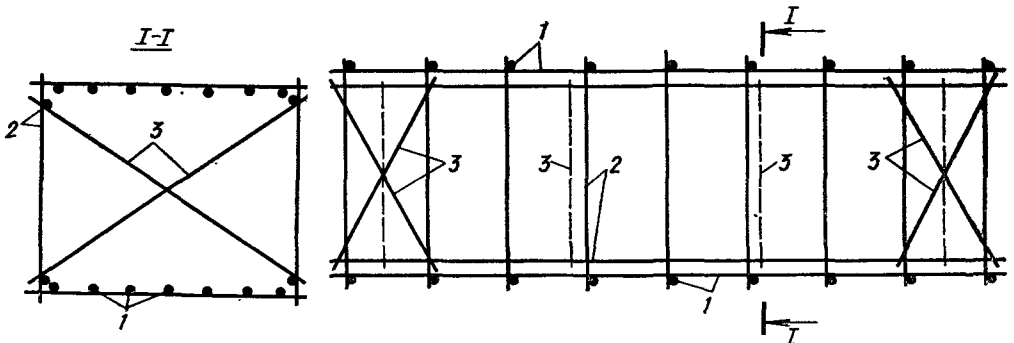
Пример арматурного каркаса железобетонной монолитной плиты:
